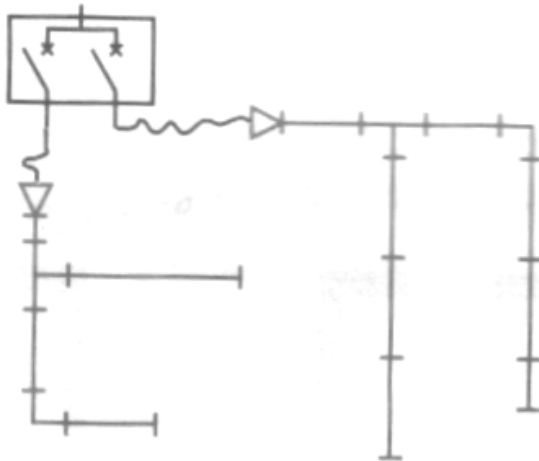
Schéma d'installation en canalisations préfabriquées.
